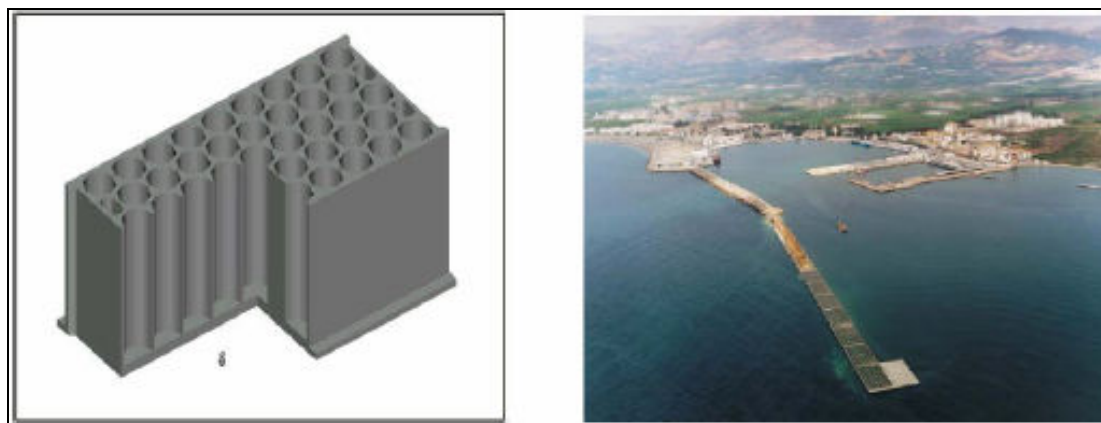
Croqui da estrutura de caixão e foto aérea de um molhe executado com ela (BERMÚDEZ, 2007).
